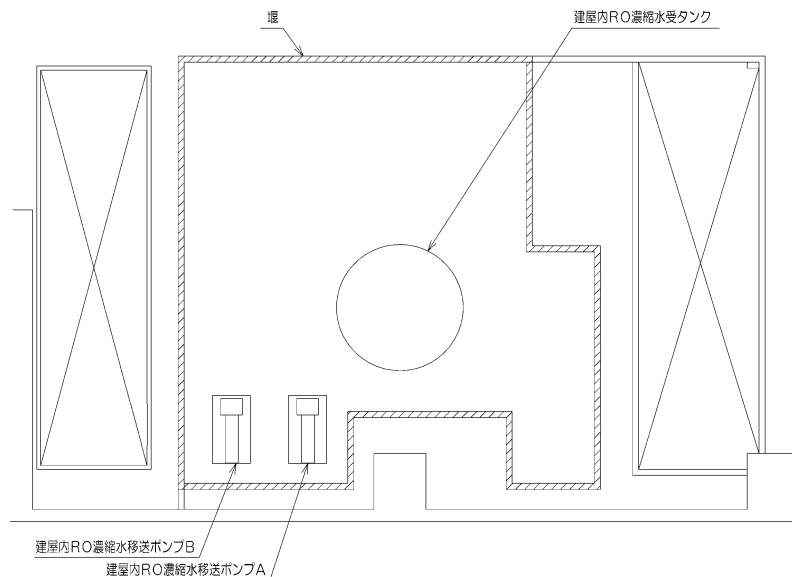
建屋内 RO 濃縮水受タンクの漏えい拡大防止 堰配置図
